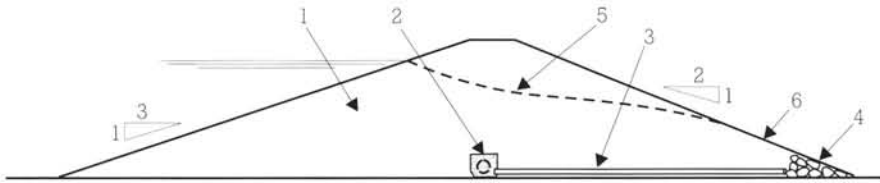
Profil type du barrage de MONTPLAISIR (Haute-Garonne).
